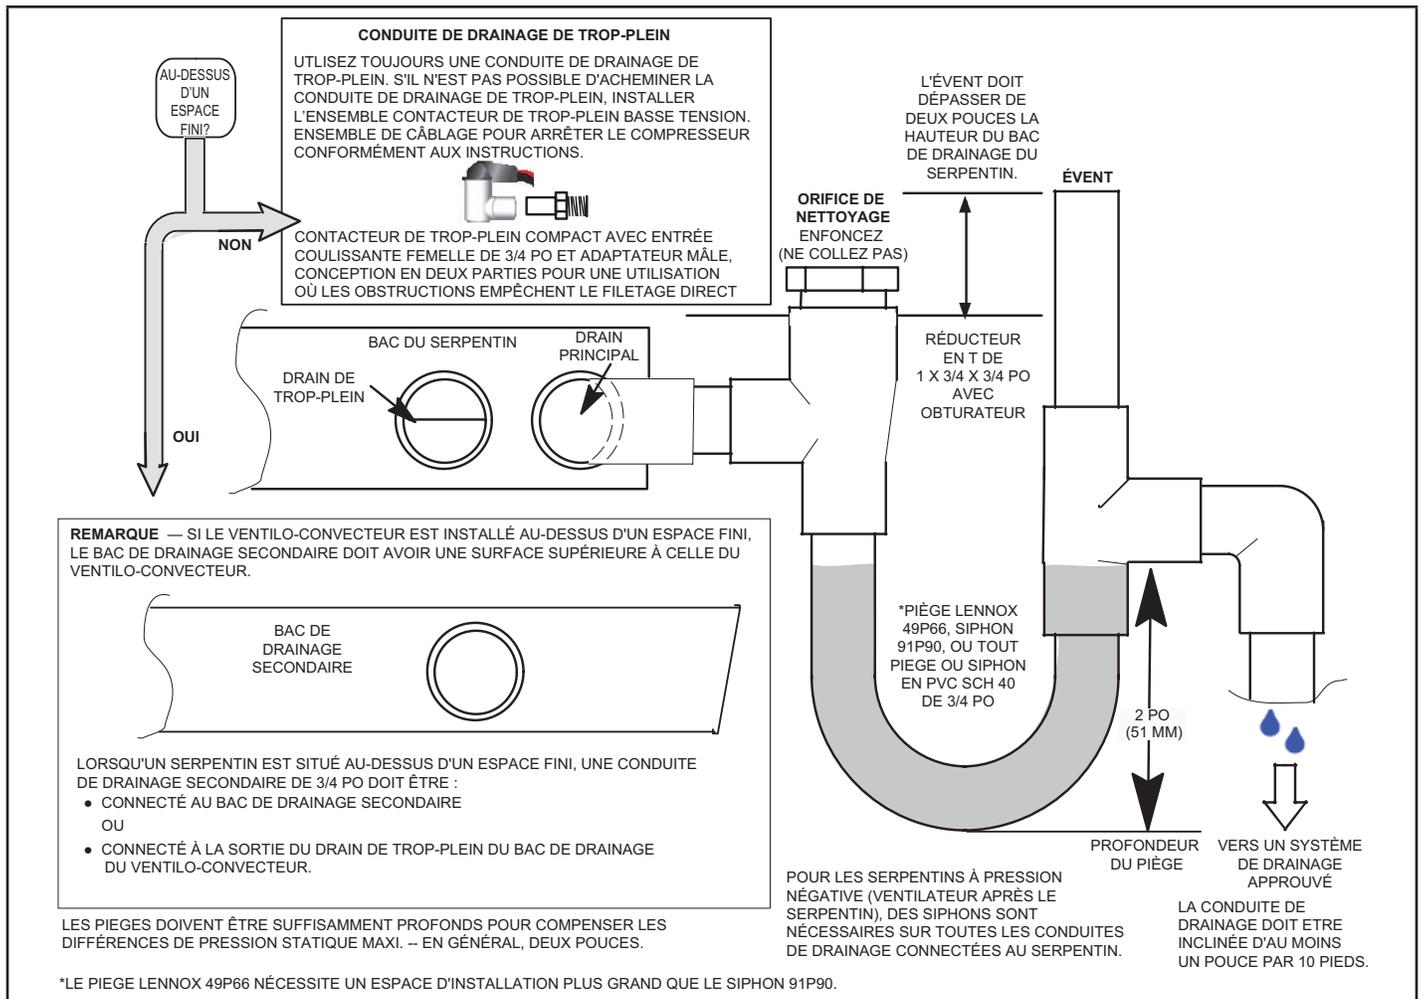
Installations typiques d'un drain principal et d'un drain de trop-plein
